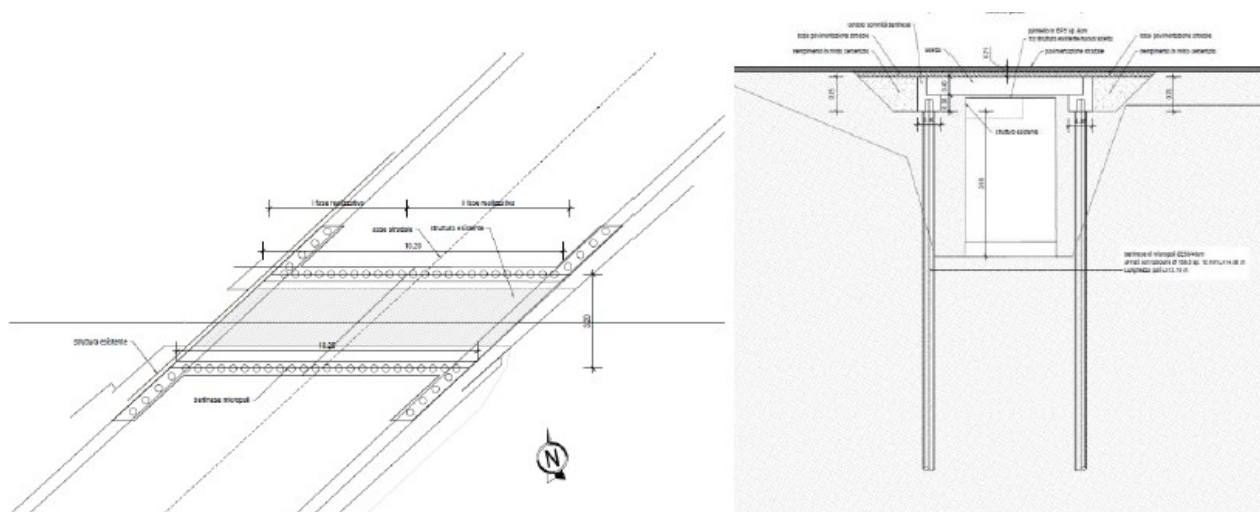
Planimetria e sezione di progetto attraversamento idraulico al km 52+050 della SS 14 (Fonte: All. 3 alla Lista di Controllo – Relazione Tecnica Generale)
